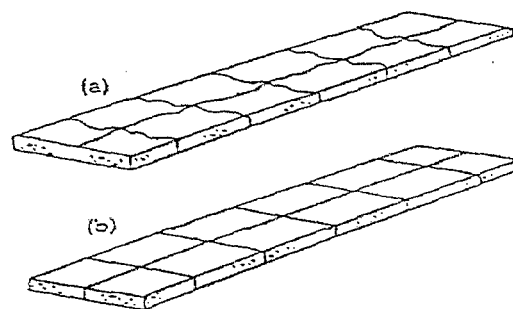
2 Patrón de agrietamiento provocado por el medio ambiente y los esfuerzos de las cargas en un pavimento de concreto sin juntas. (b) Diseño adecuado de las juntas para controlar la ubicación y geometría de las grietas en un pavimento de concreto.
